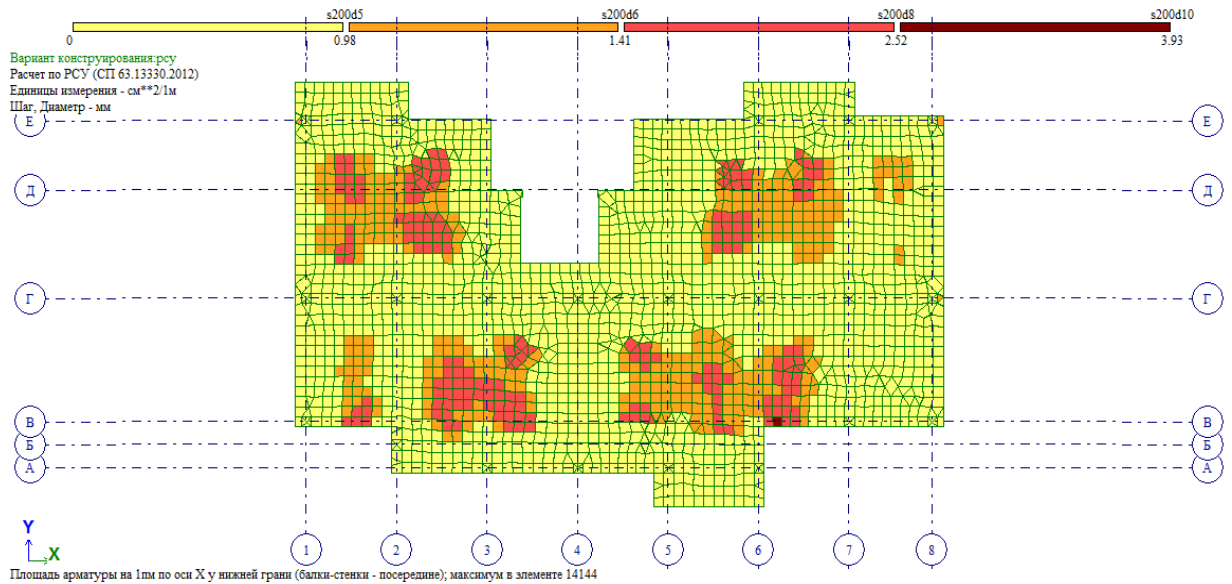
Площадь арматуры на 1 пм по оси X у нижней грани грани
